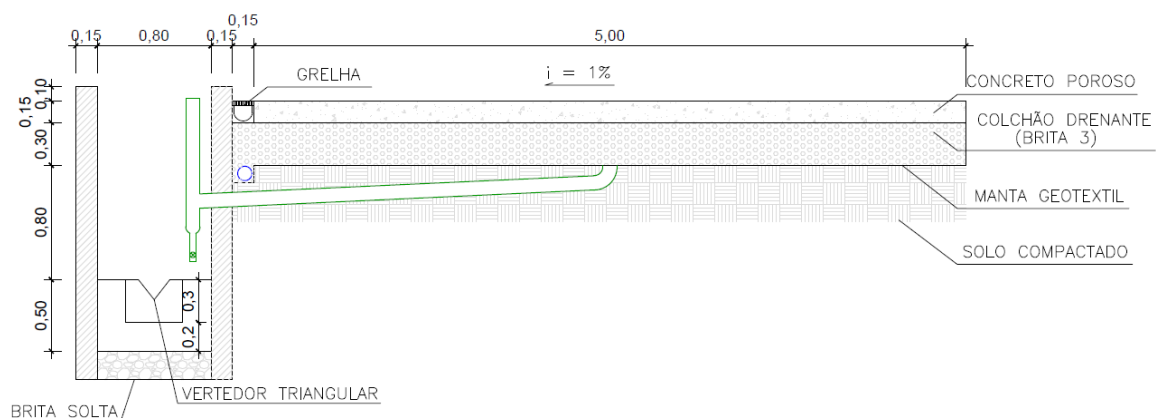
Corte DD - disposição do controle do aparato de ensaio
